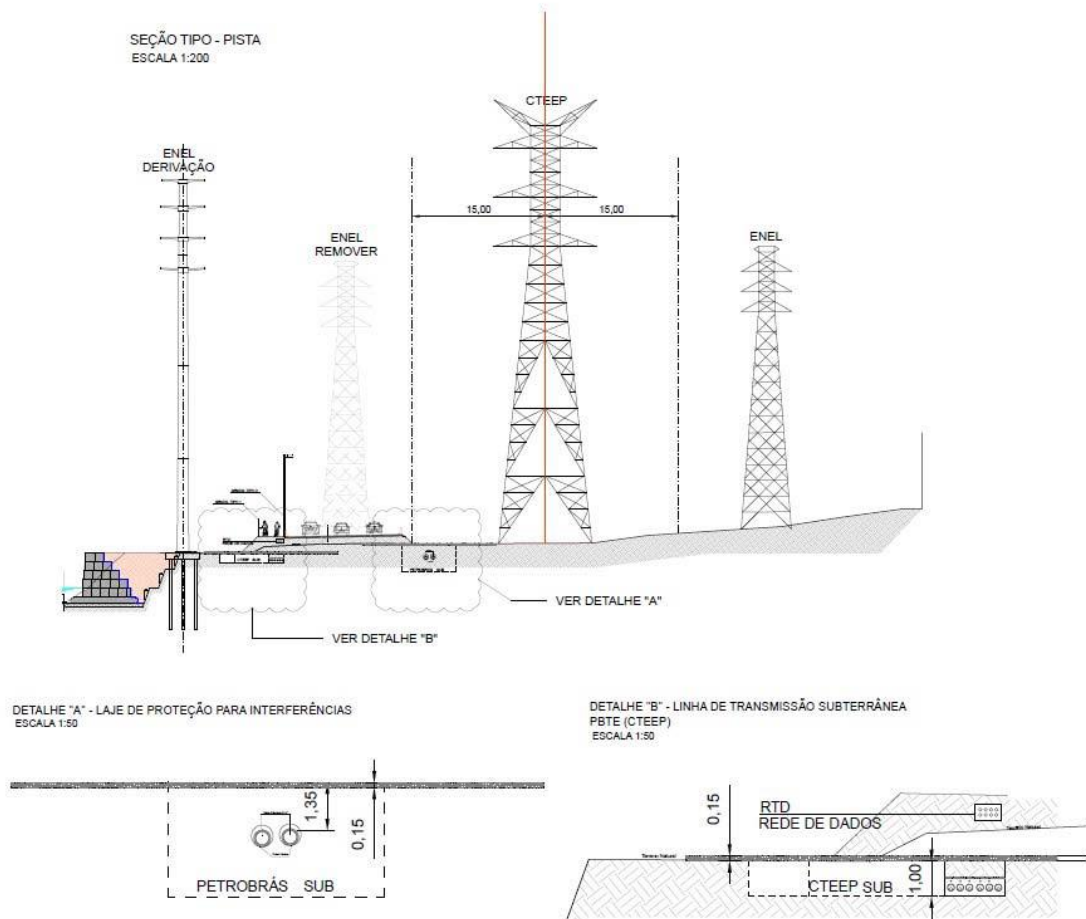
A base para o desenvolvimento do traçado foi o alinhamento de torres da CTEEP, sendo a melhor opção de traçado a utilização do espaço entre este alinhamento e a margem do rio.
